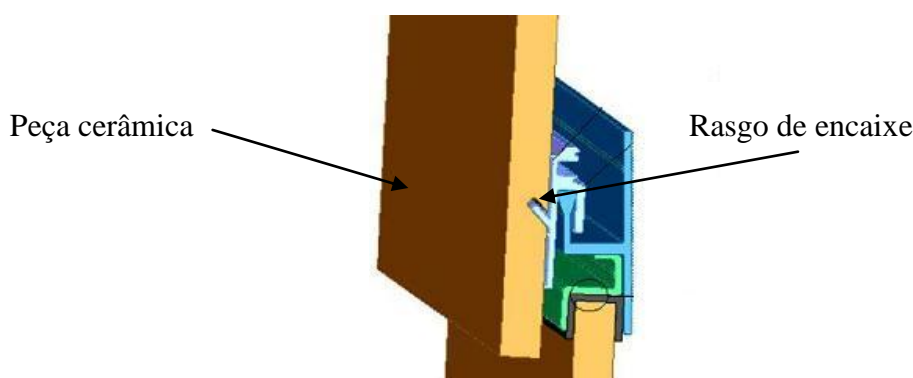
Exemplo de uma peça de grés porcelânico maquinada e a sua possível aplicação a uma fachada ventilada (adaptado de Aleluia - @2009 [10])
